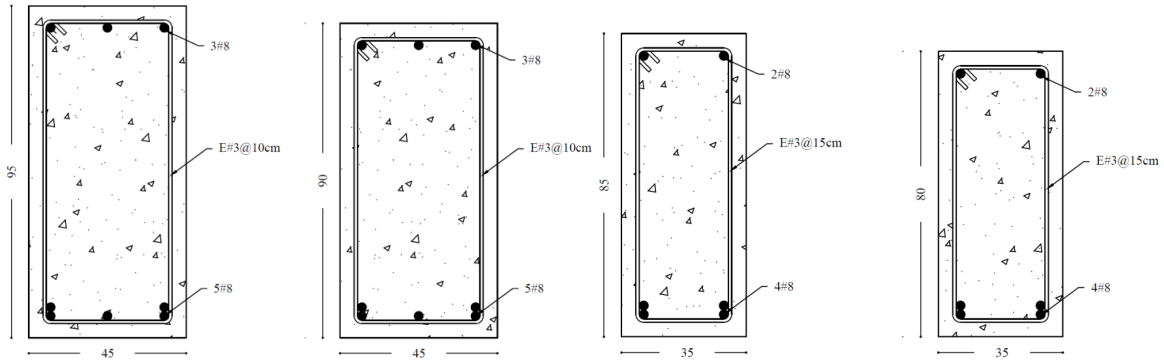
a) Sección transversal de traves para estructura sin aislamiento (par izquierdo), y b) Sección transversal de traves para estructura con aislamiento (par derecho)
